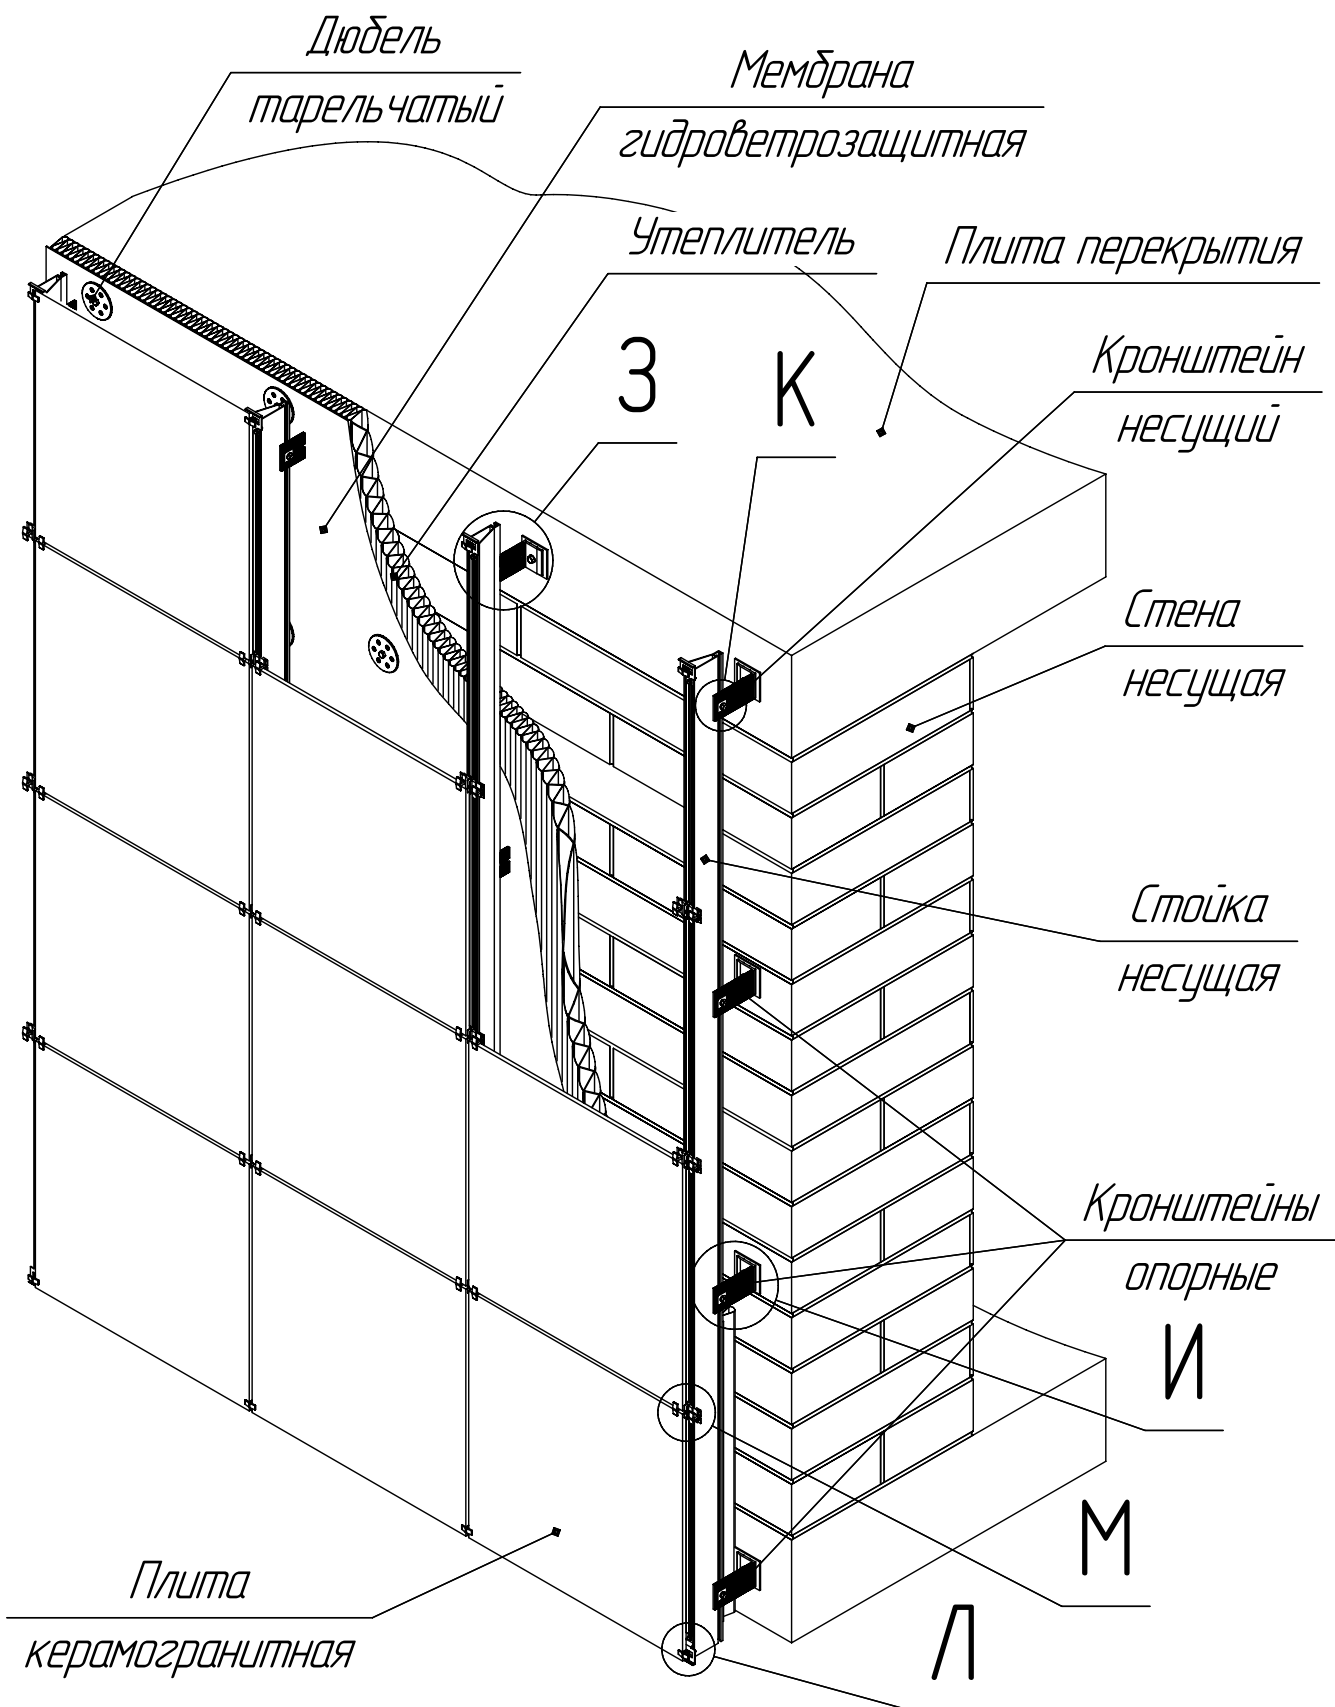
Общий вид фасада, облицованного плитам на "стандартном" участке стены
